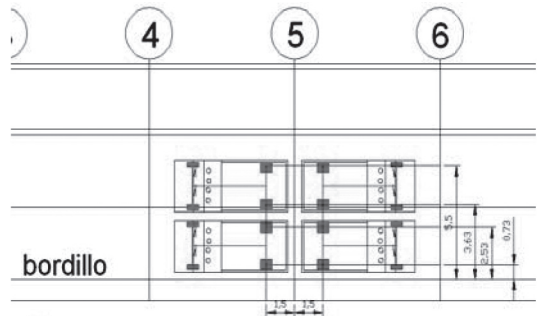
Localización en planta de las volquetas, en la primera hipótesis, localización en el tablero del puente.
